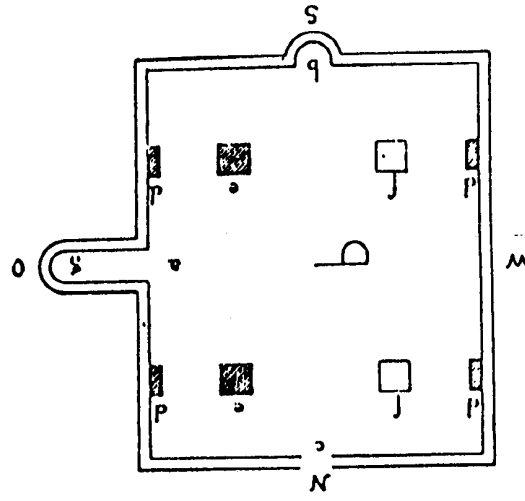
مسقط أفقي لمسجد قصر الوليد (قصر المنية)
